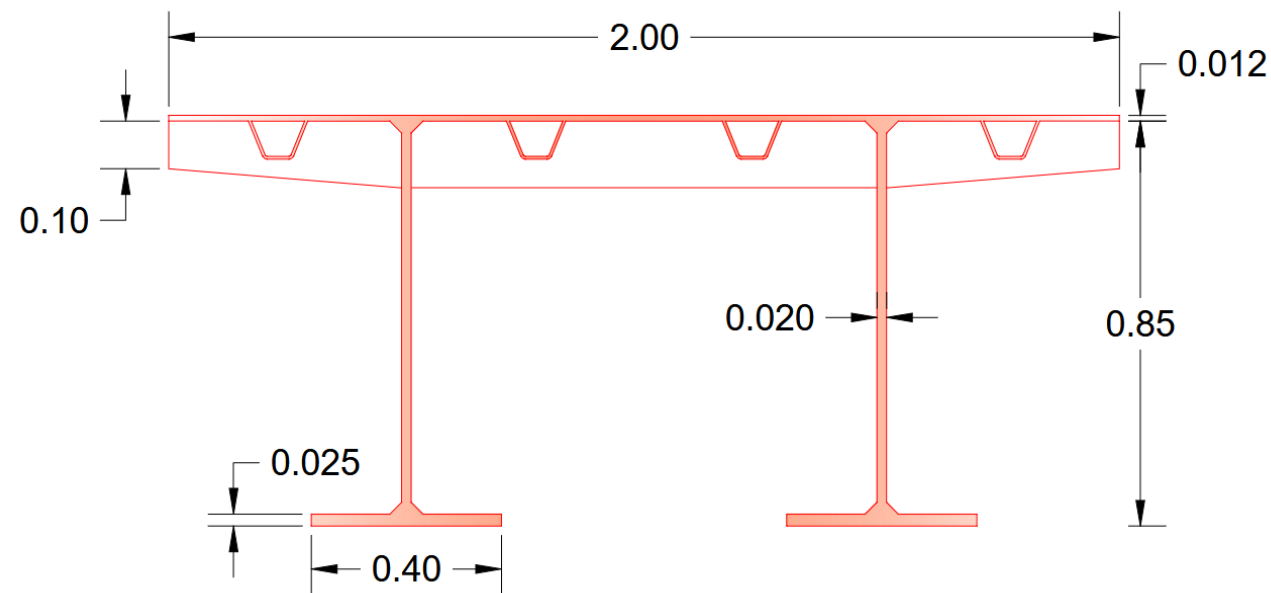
Predimensionamiento de la sección de acero estructural. Fuente: Elaboración propia
